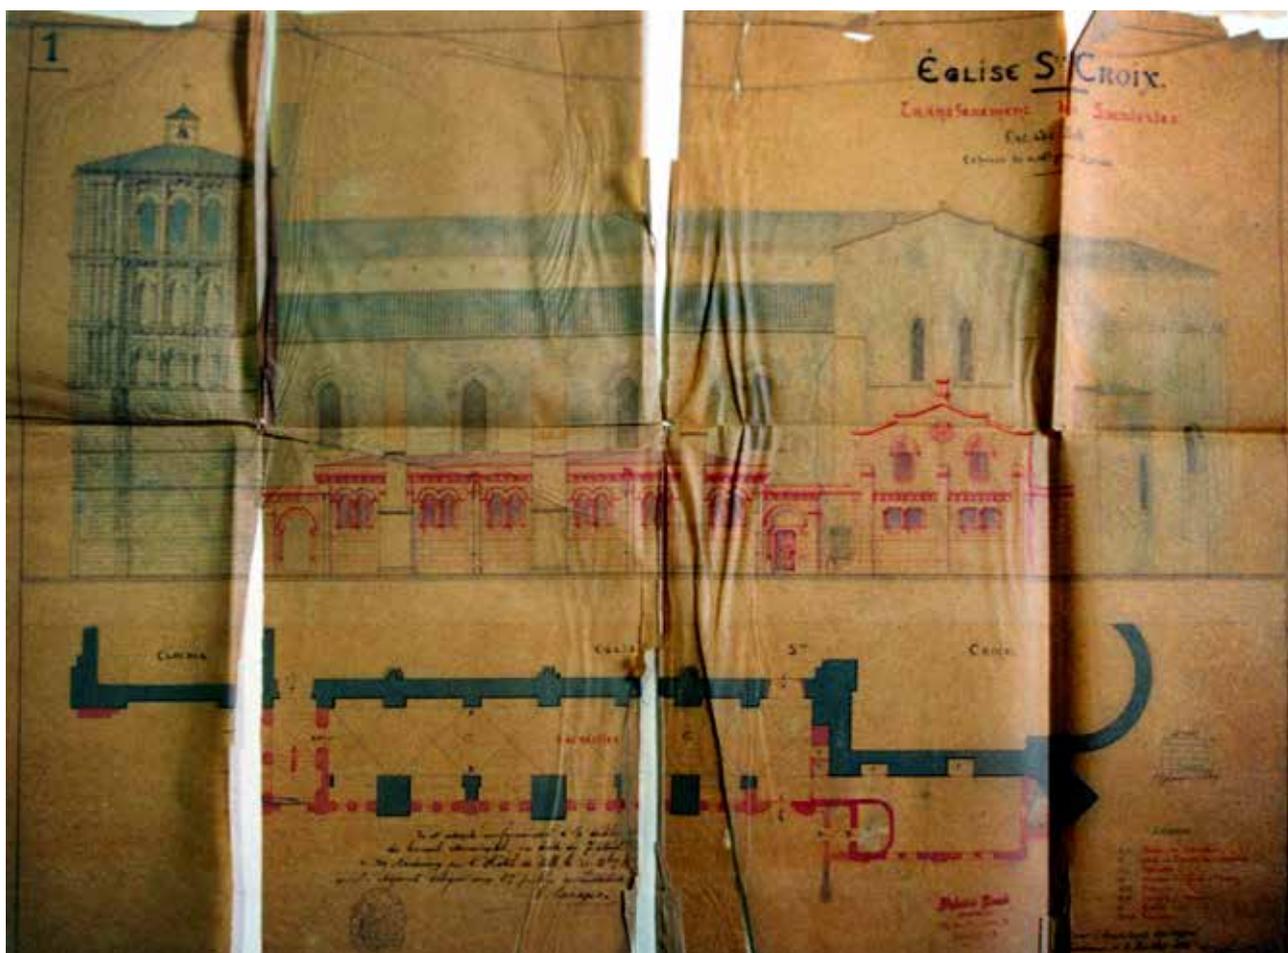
Projet de construction des sacristies par Alphonse Ricard du 2 juillet 1888 – Plan et élévation (A.M.Bx.).
